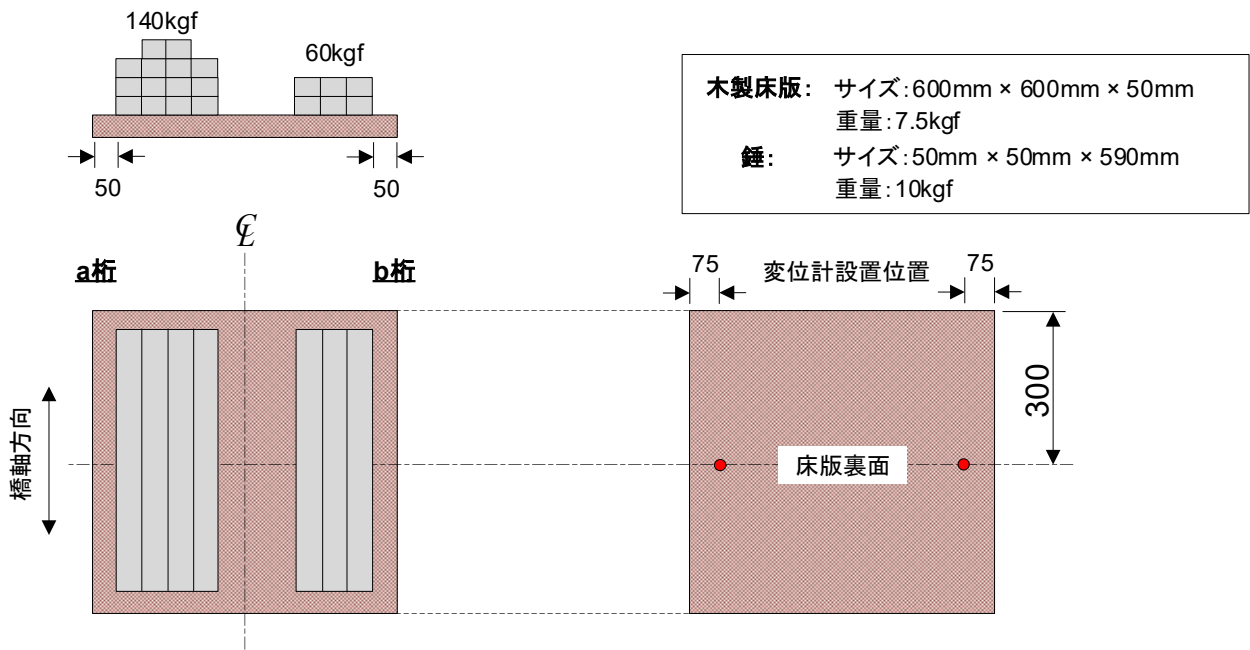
木製床版の概要および錘の設置位置 (単位 : mm)
